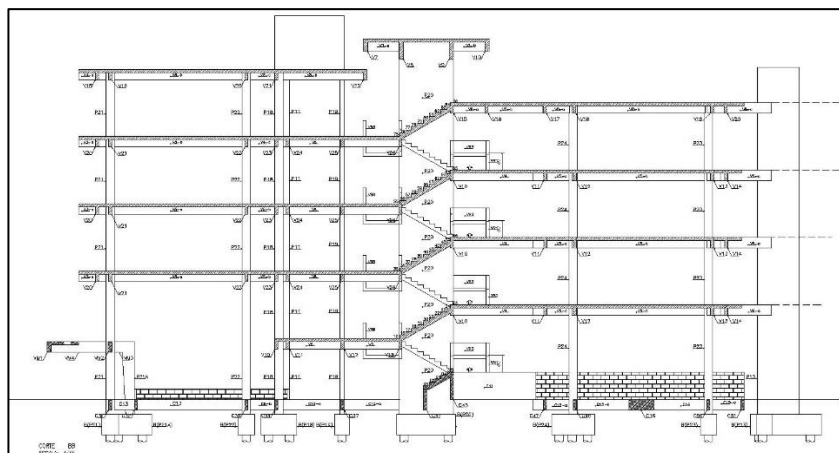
Corte longitudinal extraído do projeto de estrutura da edificação analisada.
